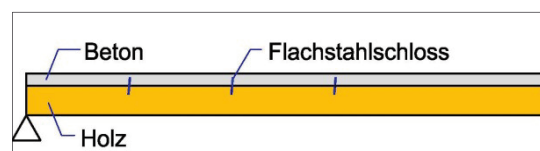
Flachstahlschloss (Einbau quer zur Spannrichtung in Brettstapel-Beton-Verbunddecken)
